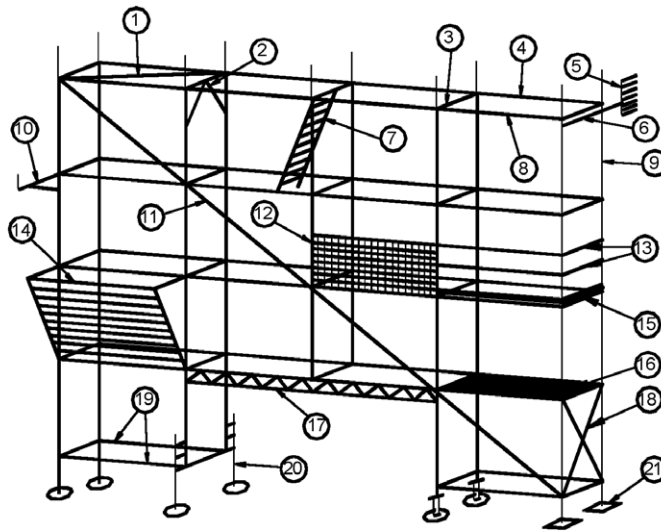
Nomenclatura degli elementi principali di un ponteggio: 1. Diagonale in pianta, 2. Archetto di rinforzo telaio, 3. Collegamento trasversale, 4. Corrente posteriore, 5. Ancoraggio, 6. Collegamento, 7. Scaletta, 8. Traverso, 9. Montante, 10. Apparecchio sollevatore, 11. Diagonale di facciata, 12. Graticcio di protezione, 13. Doppio parapetto, 14. Mantovana o parasassi, 15. Fermapiede, 16. Impalcato, 17. Trave passo-carraio, 18. Rinforzo al primo livello, 19. Rinforzo alla base, 20. Pezzo speciale, 21. Basetta fissa o regolabile.
